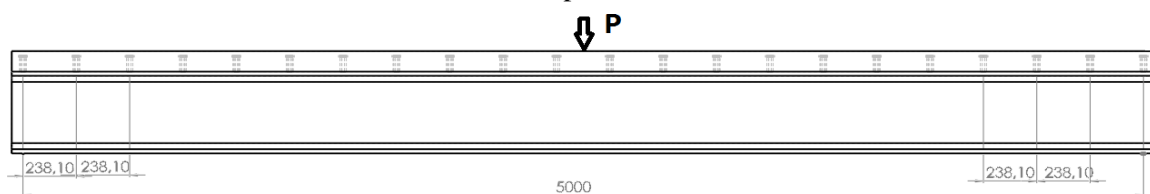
la coupe longitudinale d'une poutre mixte avec 44 goujons
